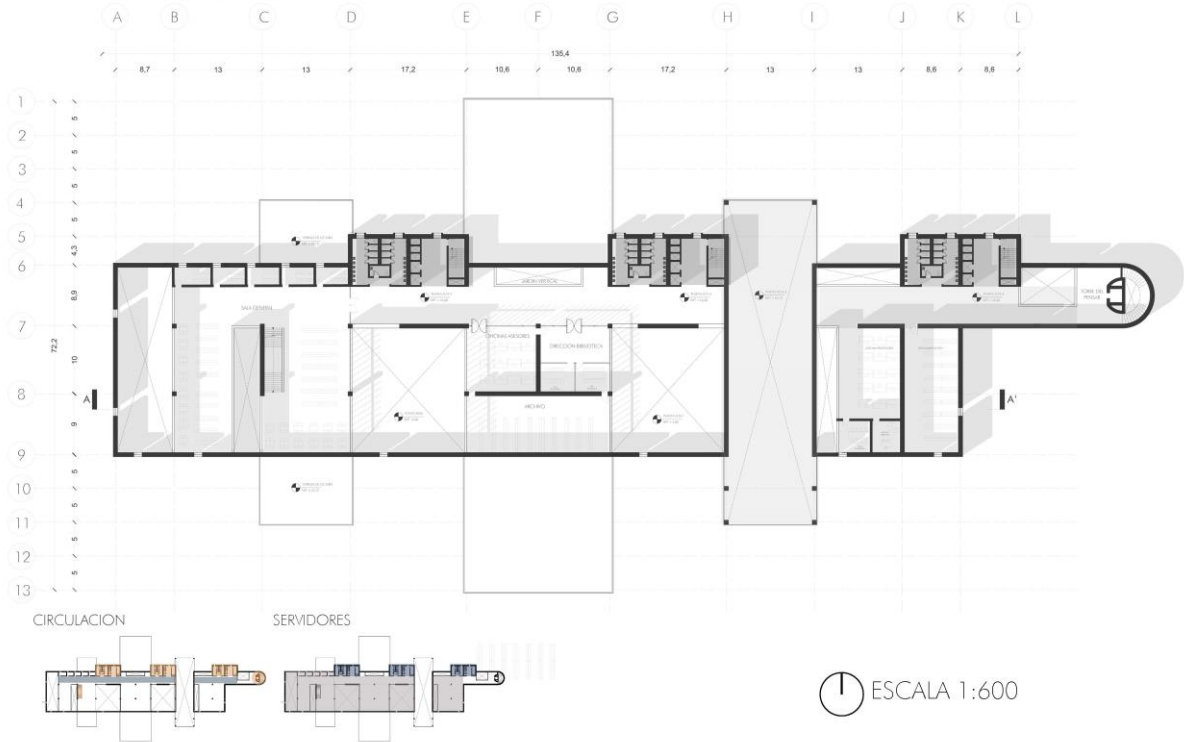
Planta Alta 4 Nivel +12.72 m Fuente: Autor
